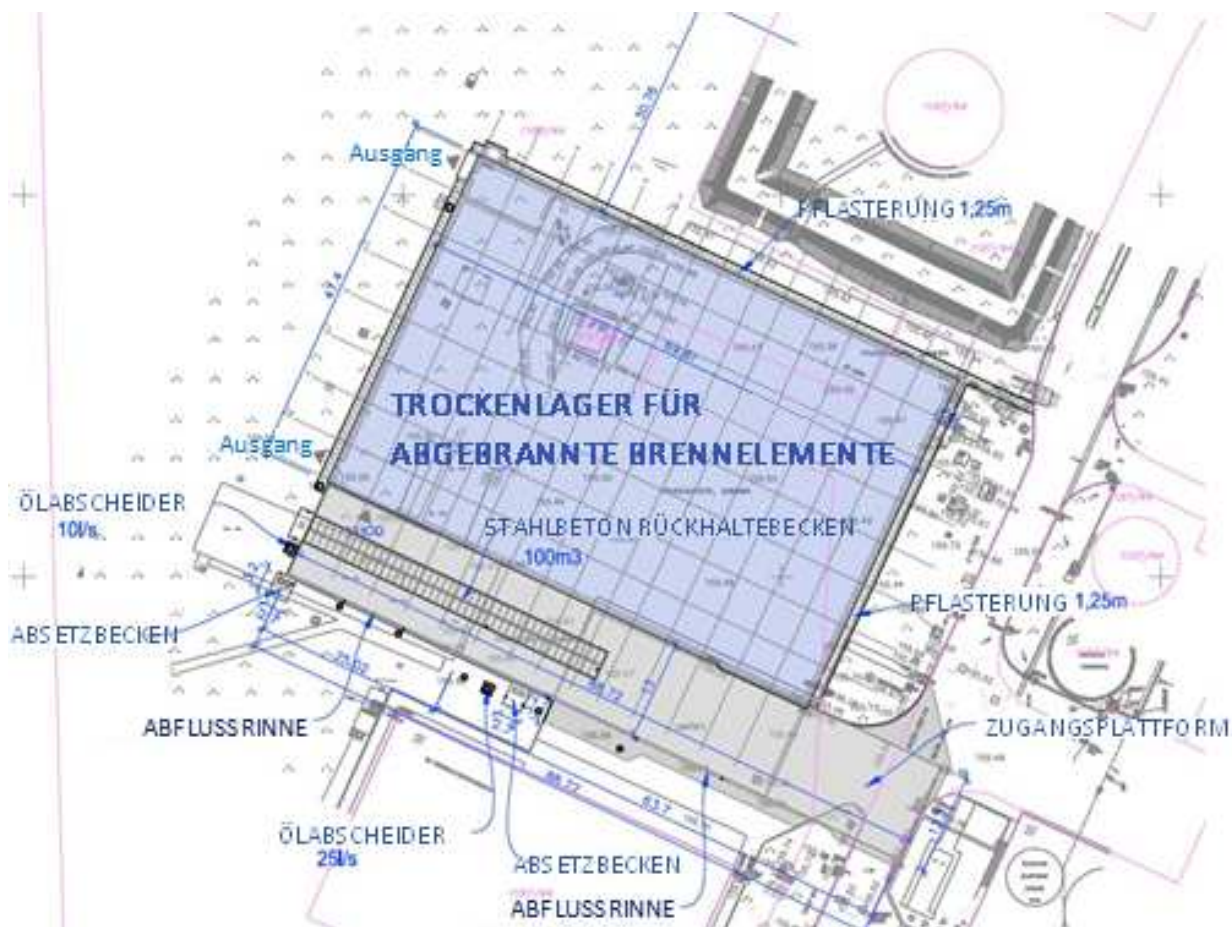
Lageplan des Trockenlagergebäudes mit Zugangsplattform
